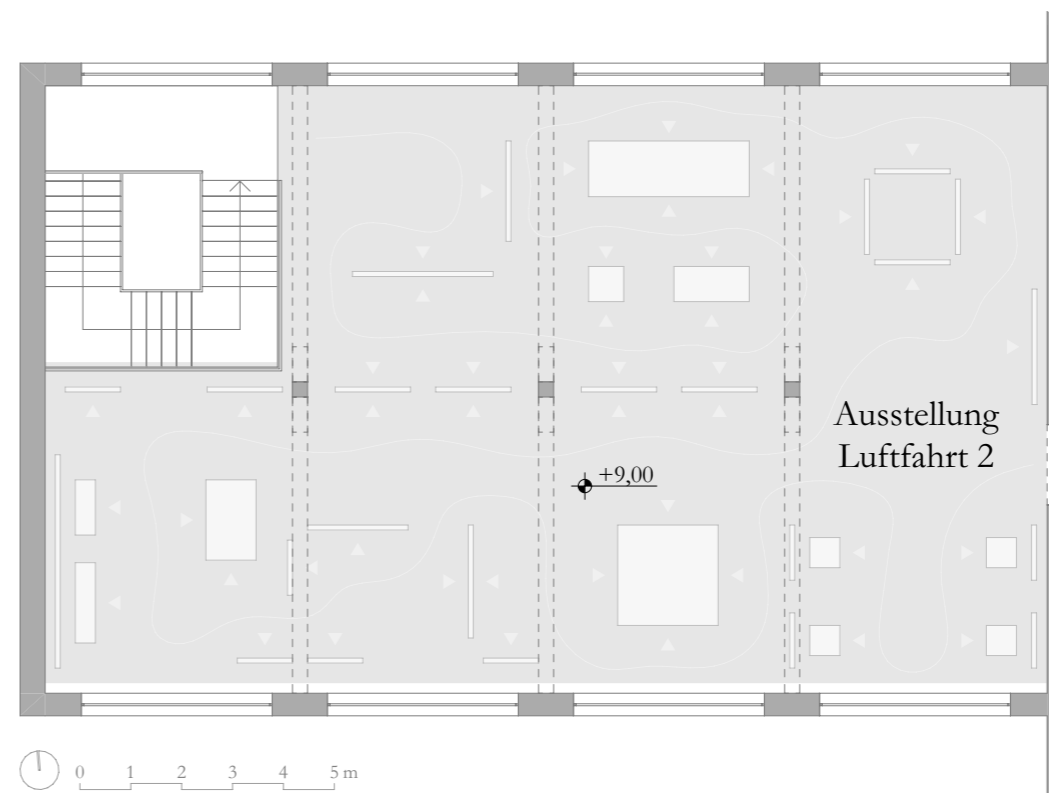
Grundriss Dachgeschoss (Detail Ausstellung Luftfahrt) M 1:150
